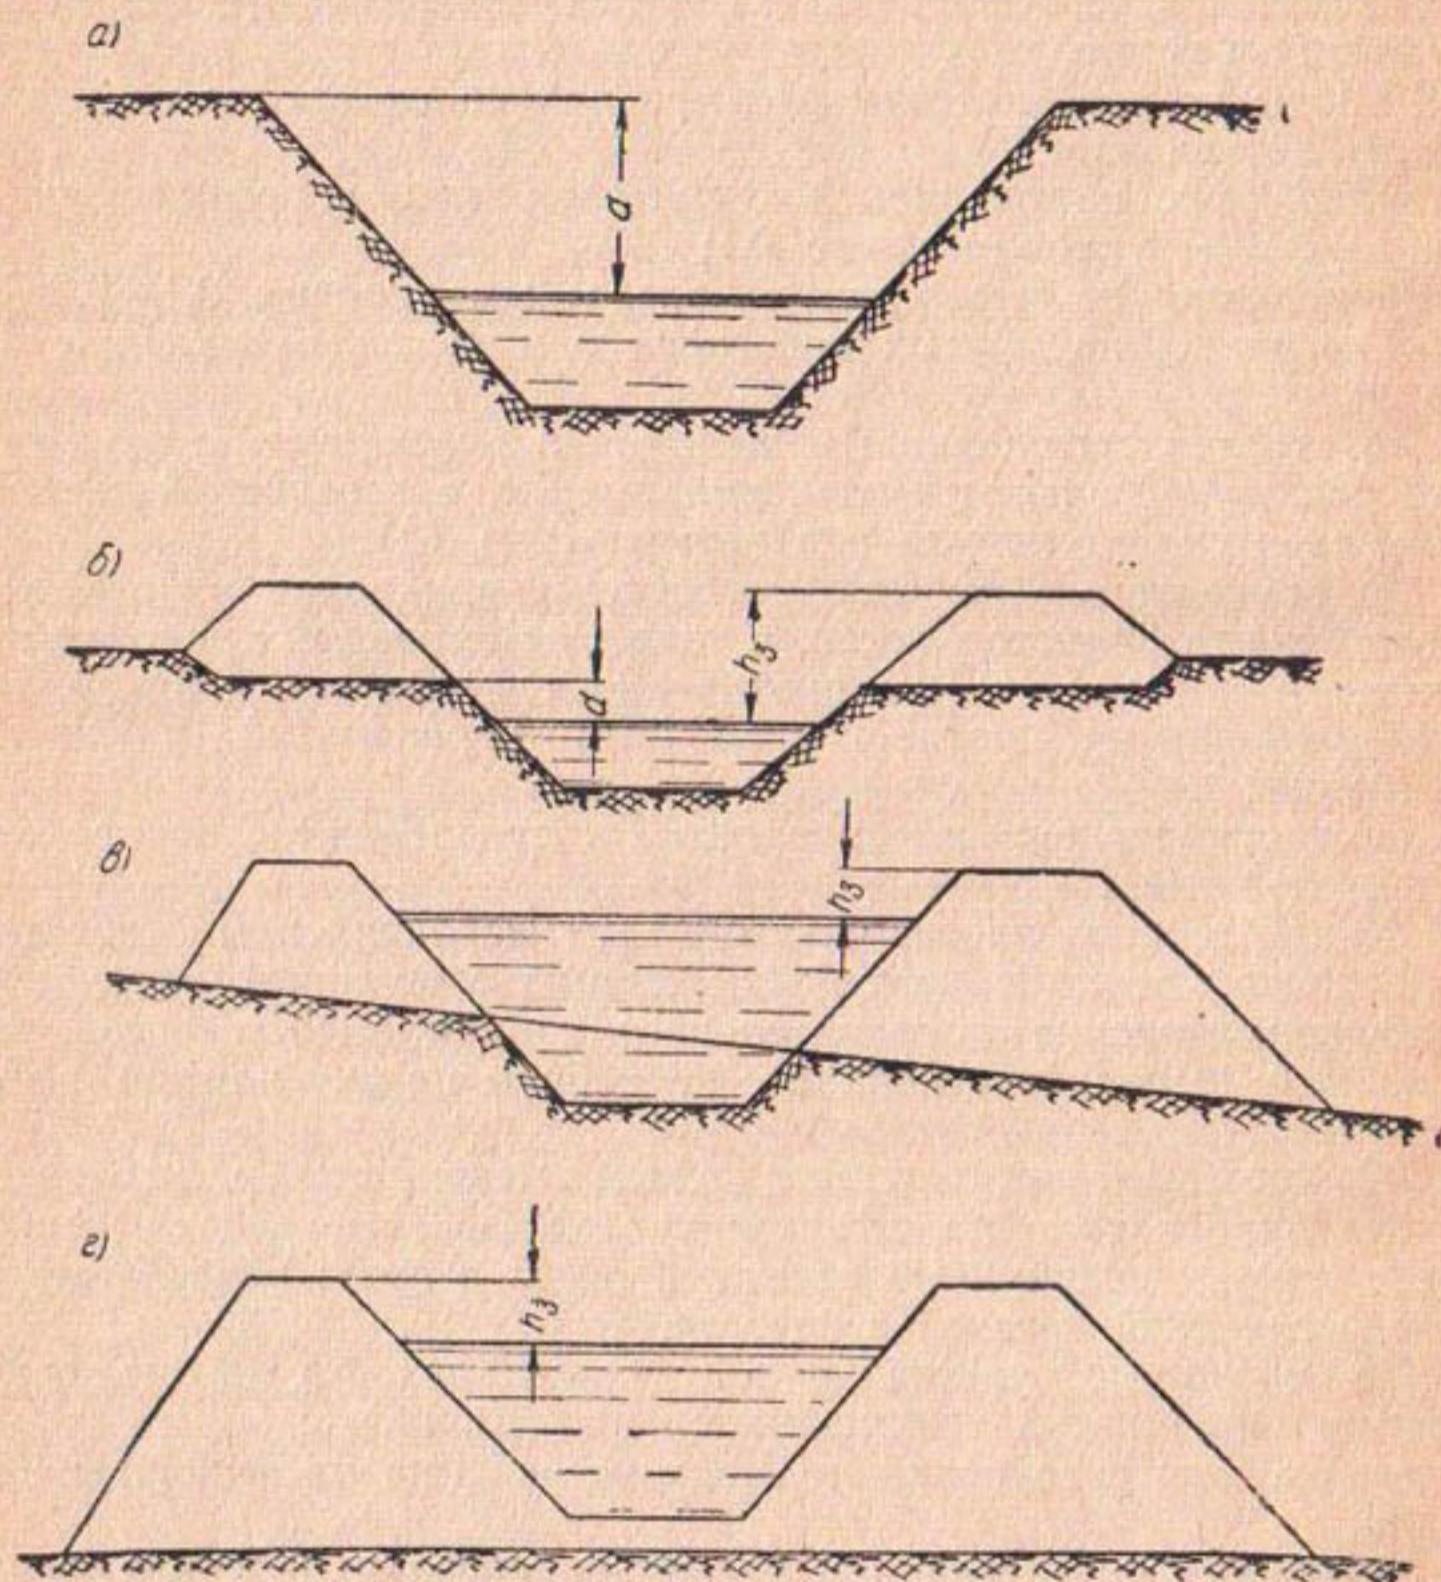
Поперечные сечения каналов на лёссовых просадочных грунтах:
